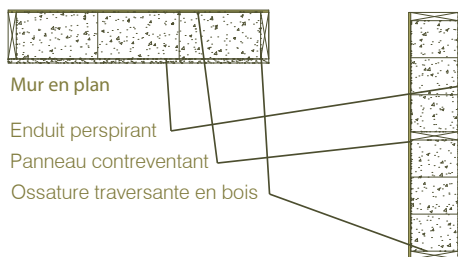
Vue en coupe et en plan du système Casacalida.
